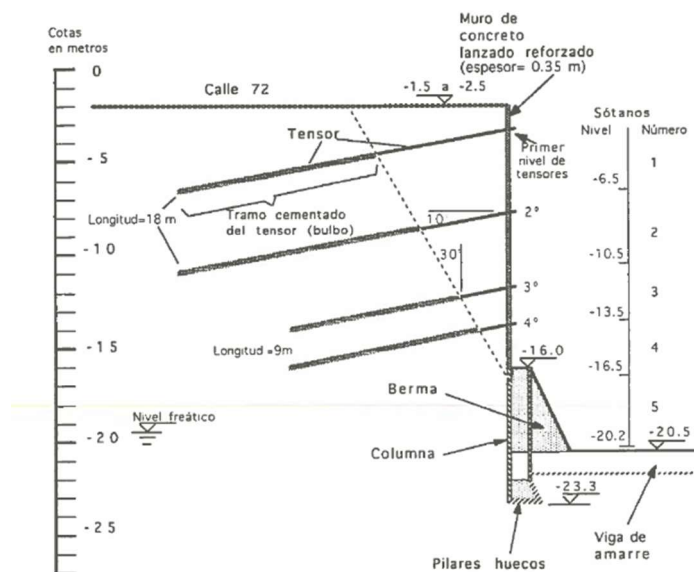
Configuración del Muro colapsado en la calle 72 en 1994
